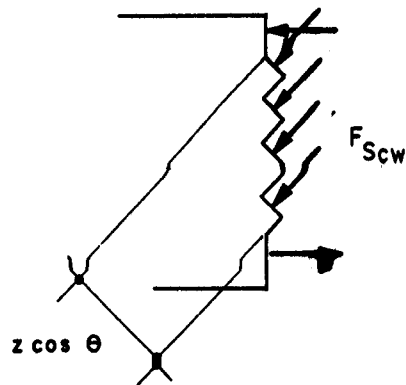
COMPRESSÃO NA BIELA DE CONCRETO - CEB/90⁵
